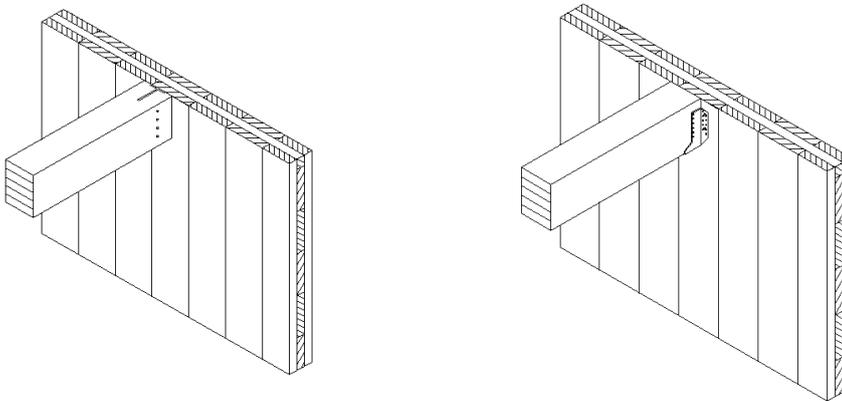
Collegamento di una trave alla parete mediante staffe metalliche
